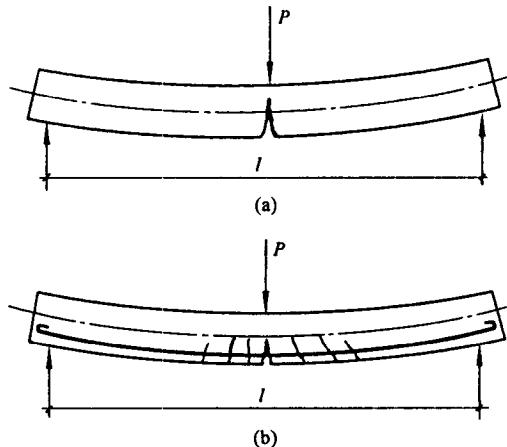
素混凝土梁和钢筋混凝土梁的破坏情况
